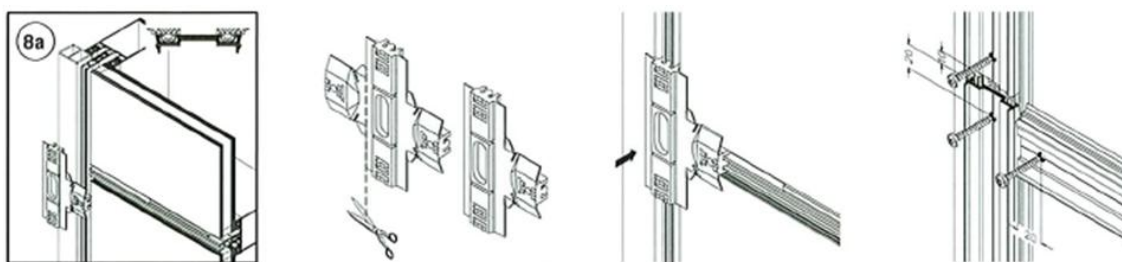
Schüco FW 50+ krok 6 [16]
